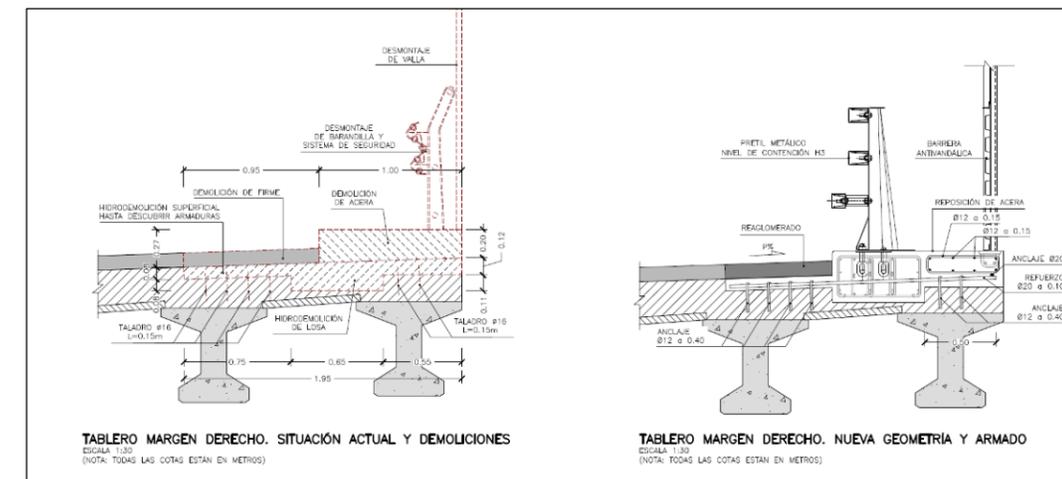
Detalle de anclaje de pretil en tablero de la estructura de la M-600 P.K.8+000. (Fuente: Elaboración propia. Octubre de 2013).
